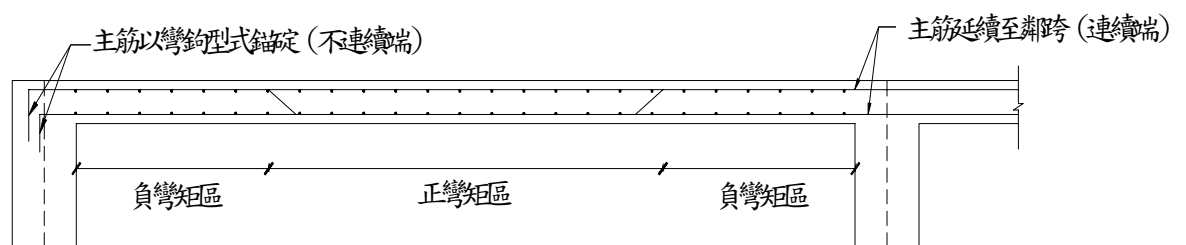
鋼筋混凝土版鋼筋配置細節需求
